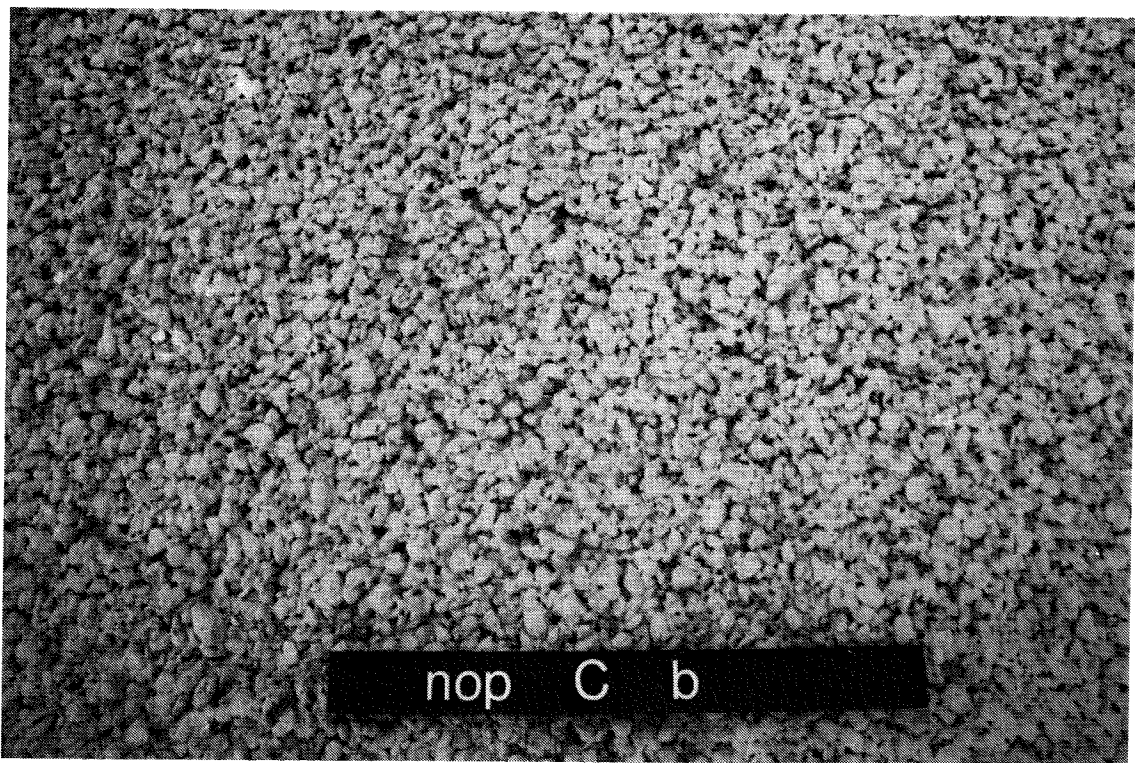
Fijn open colloïdaal beton (4-16 mm)
